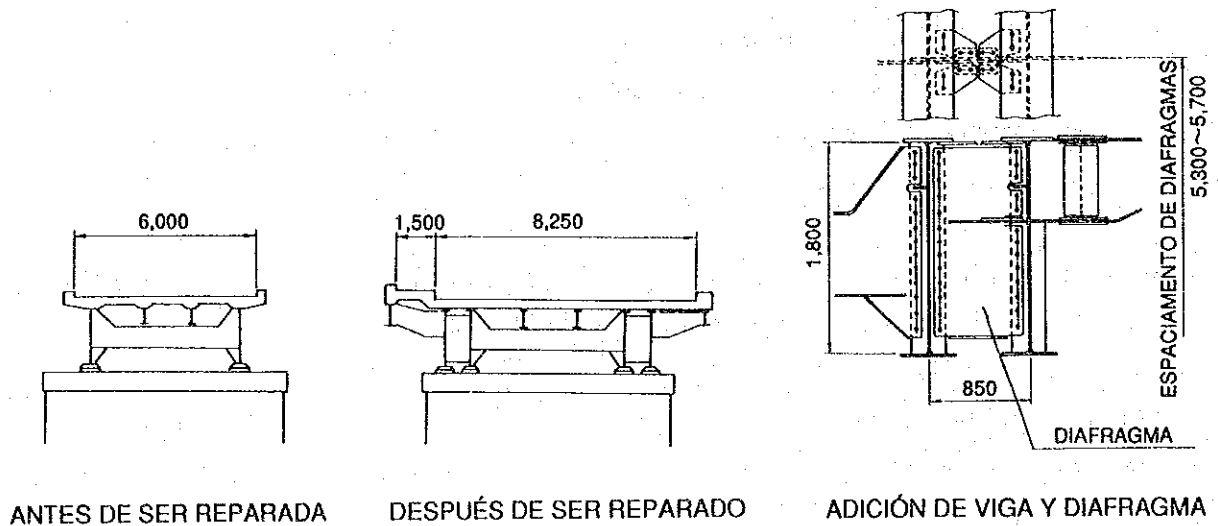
Ejemplo de instalación de una nueva viga de refuerzo
